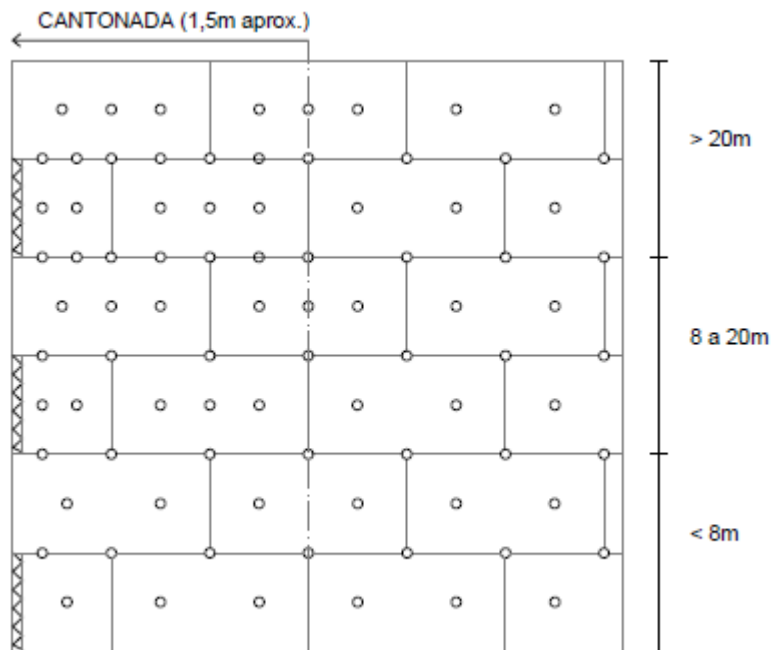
Disposició d'encastament de espigues sobre el panell aïllant.
